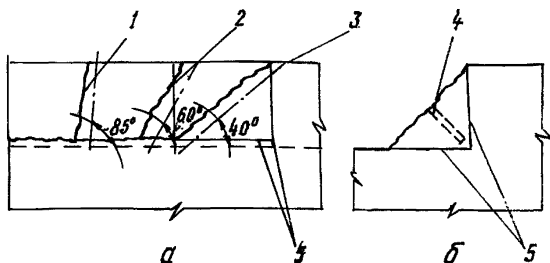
Характерные профили отколов при разрушении бетонного фундамента и регулирование угла откола:
